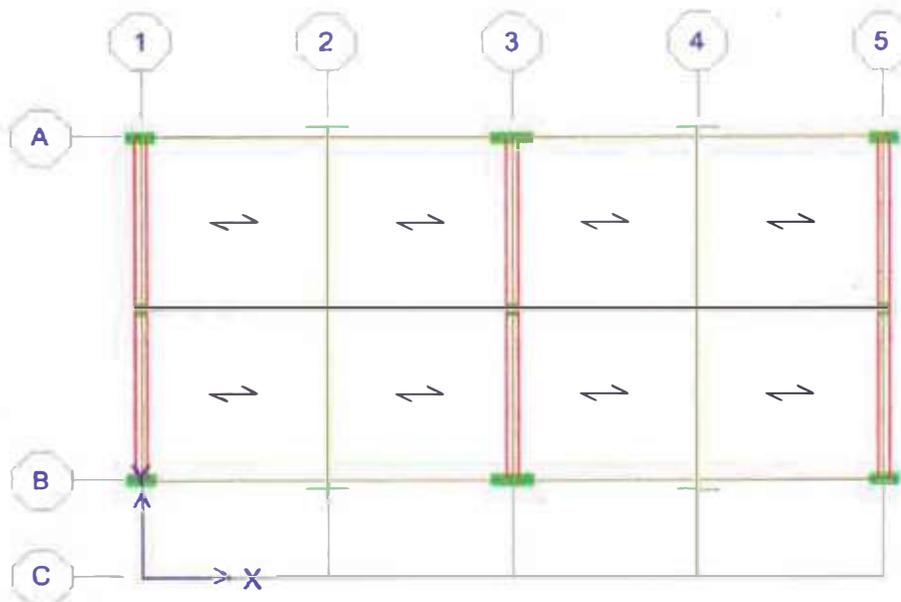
Planta del 2º Piso mostrando sus elementos.
